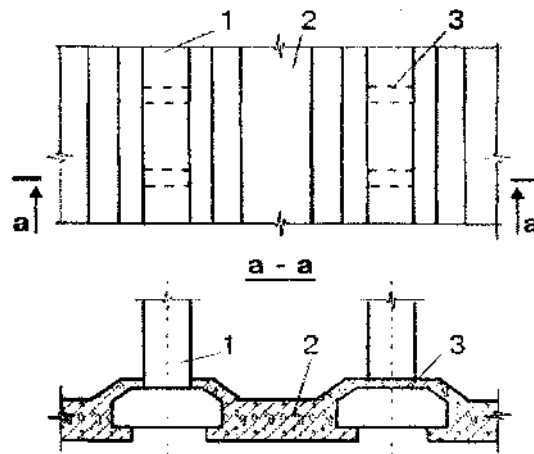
Схема підсилення стрічкових фундаментів перевлаштуванням їх в плитні: 1 – фундаменти, що підсилюються; 2 – залізобетонна плита; 3 – отвір для пропуску обійм
